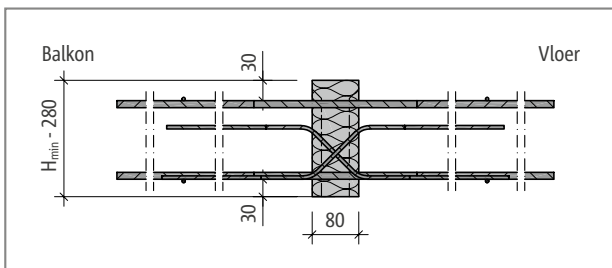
Schöck Isokorb® T type D-MM4-VV1 in lengte L500: Bovenaanzicht
